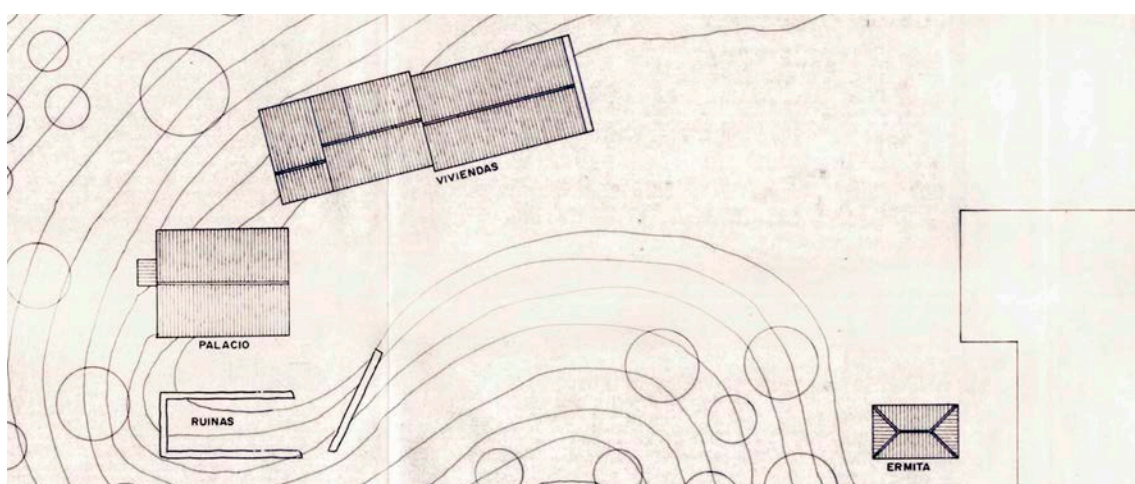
El Bosque de La Serreta en Lastras de Cuéllar. Plano de conjunto (fuente: Hernández Montero, 1994).
